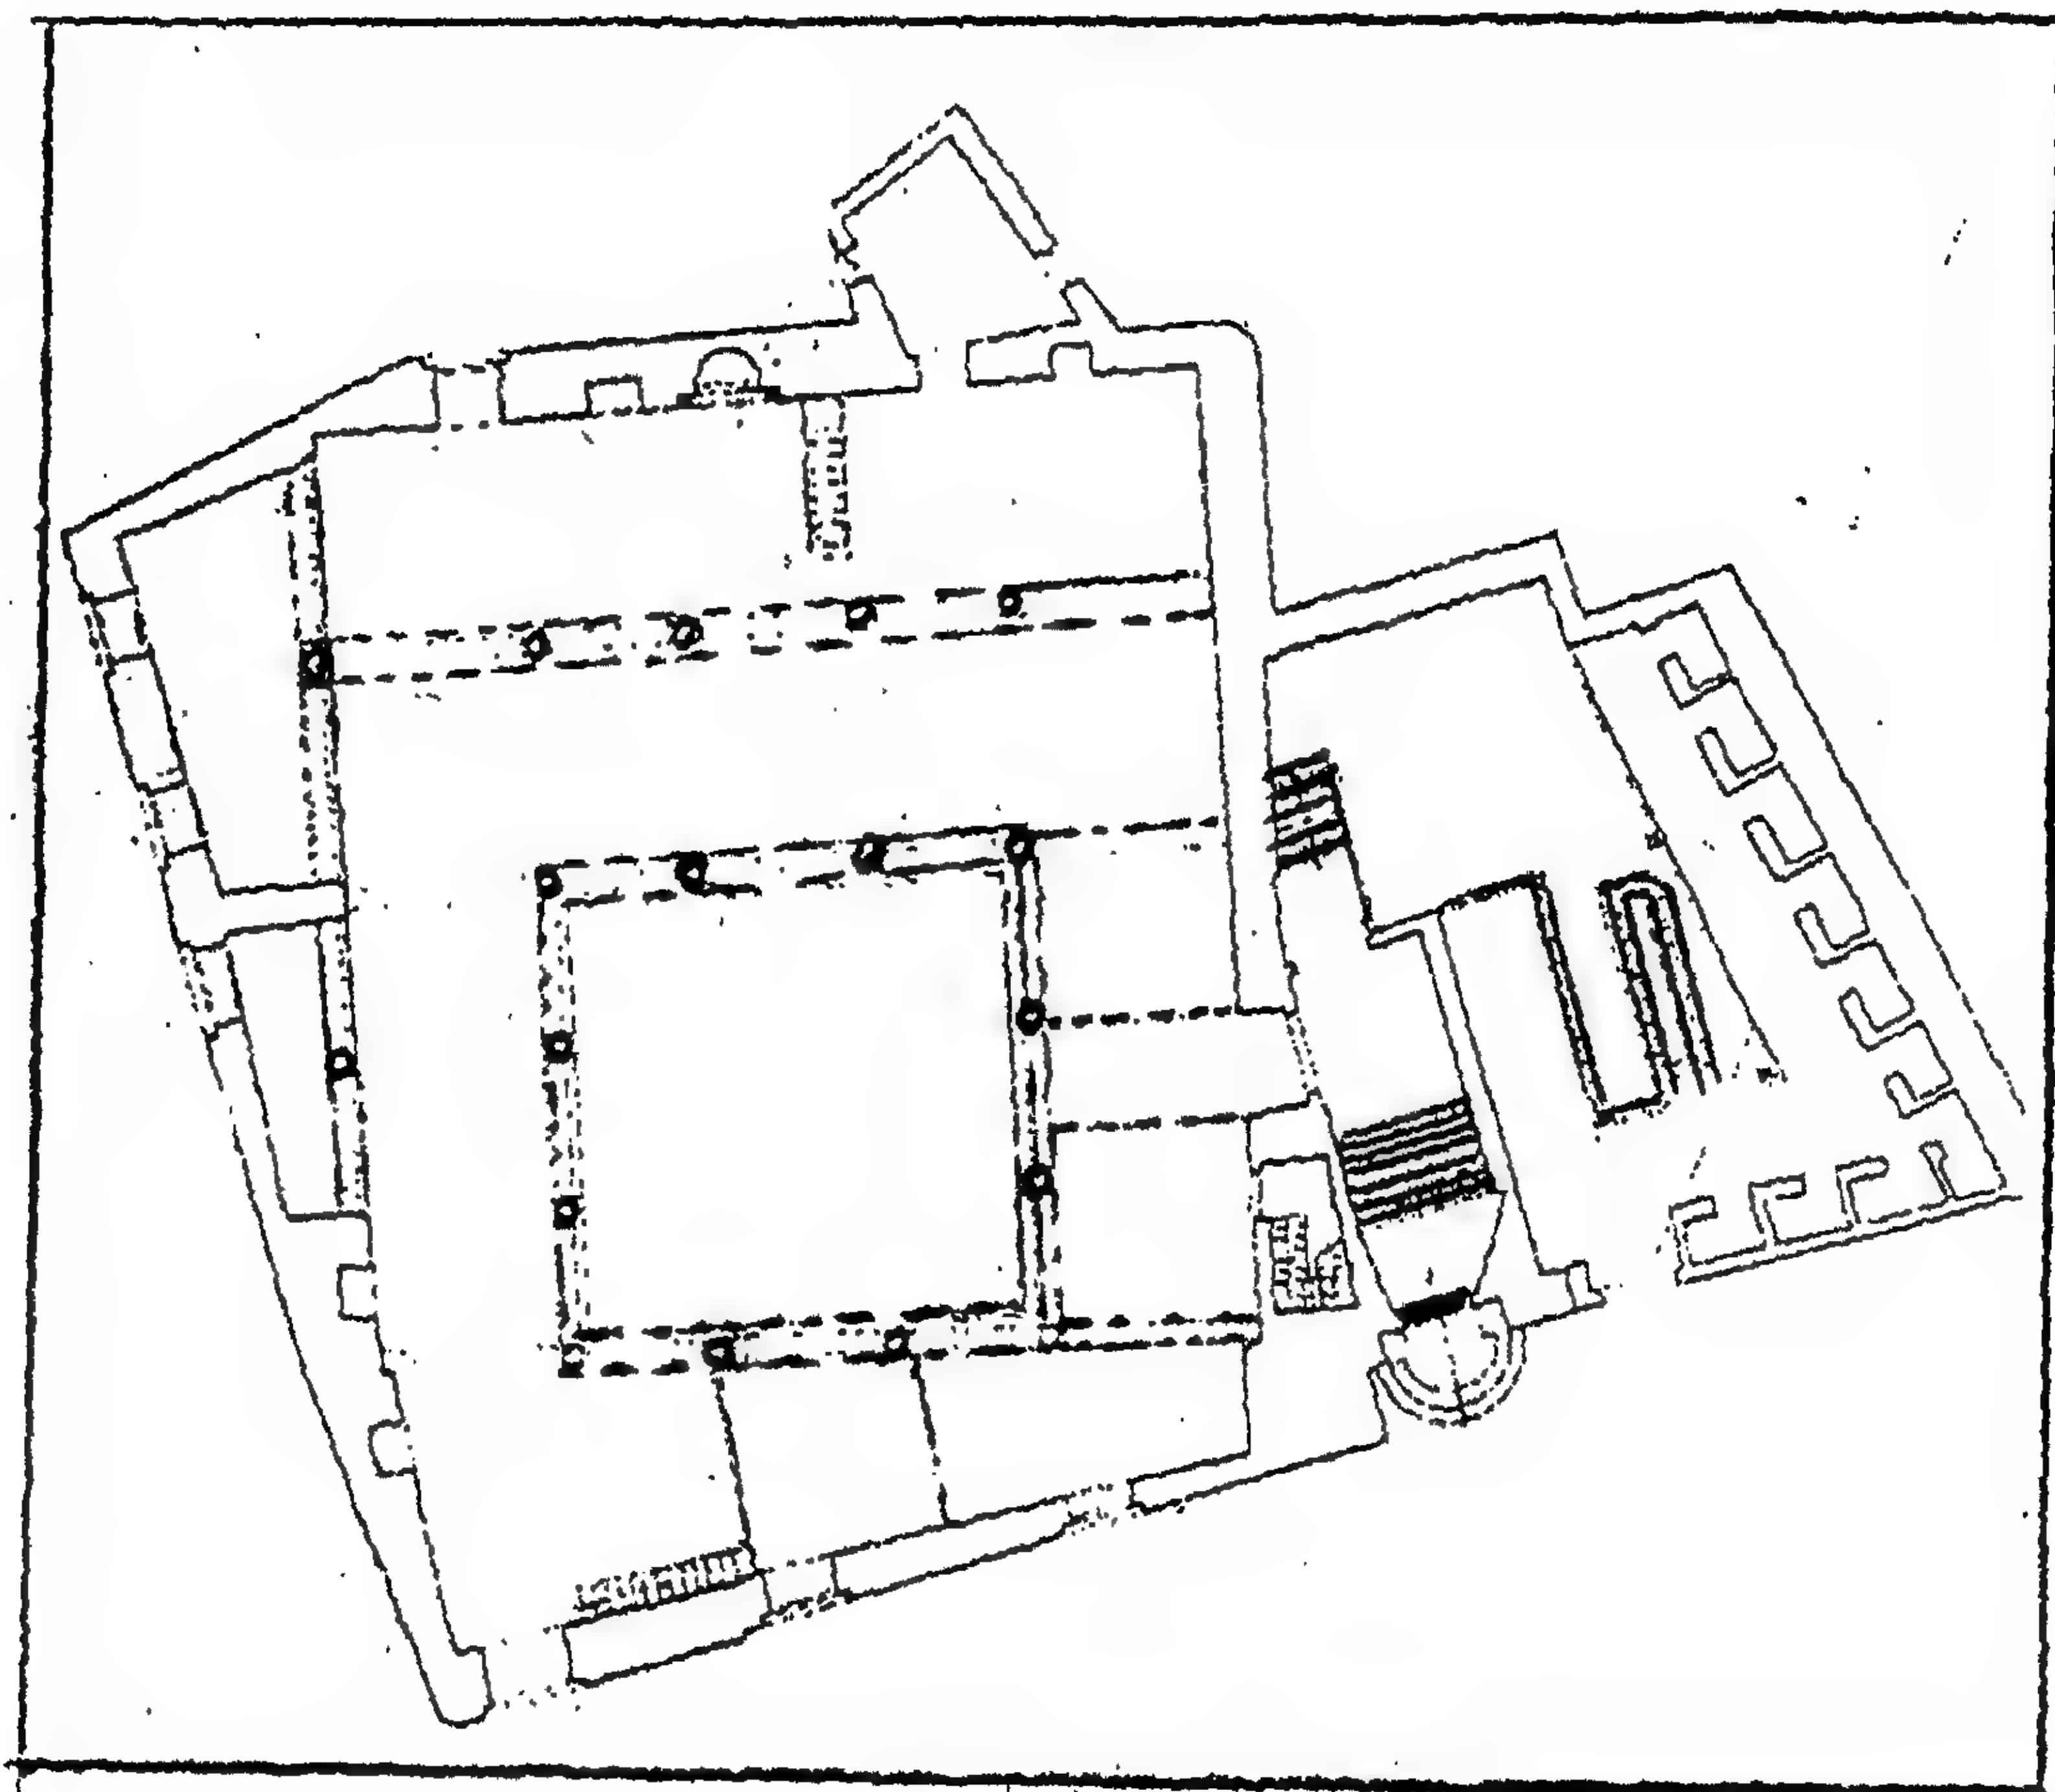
مسقط أفقى لجامع محمد كتخدا مستحفظان الشهير بجامع الحبشلى.
